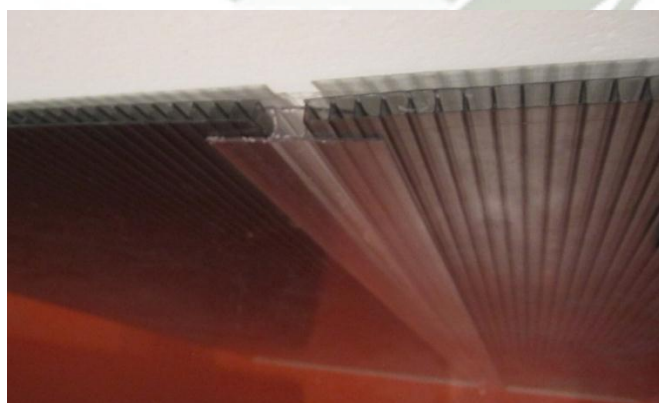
Elección y posicionamiento de los perfiles en H de plástico
